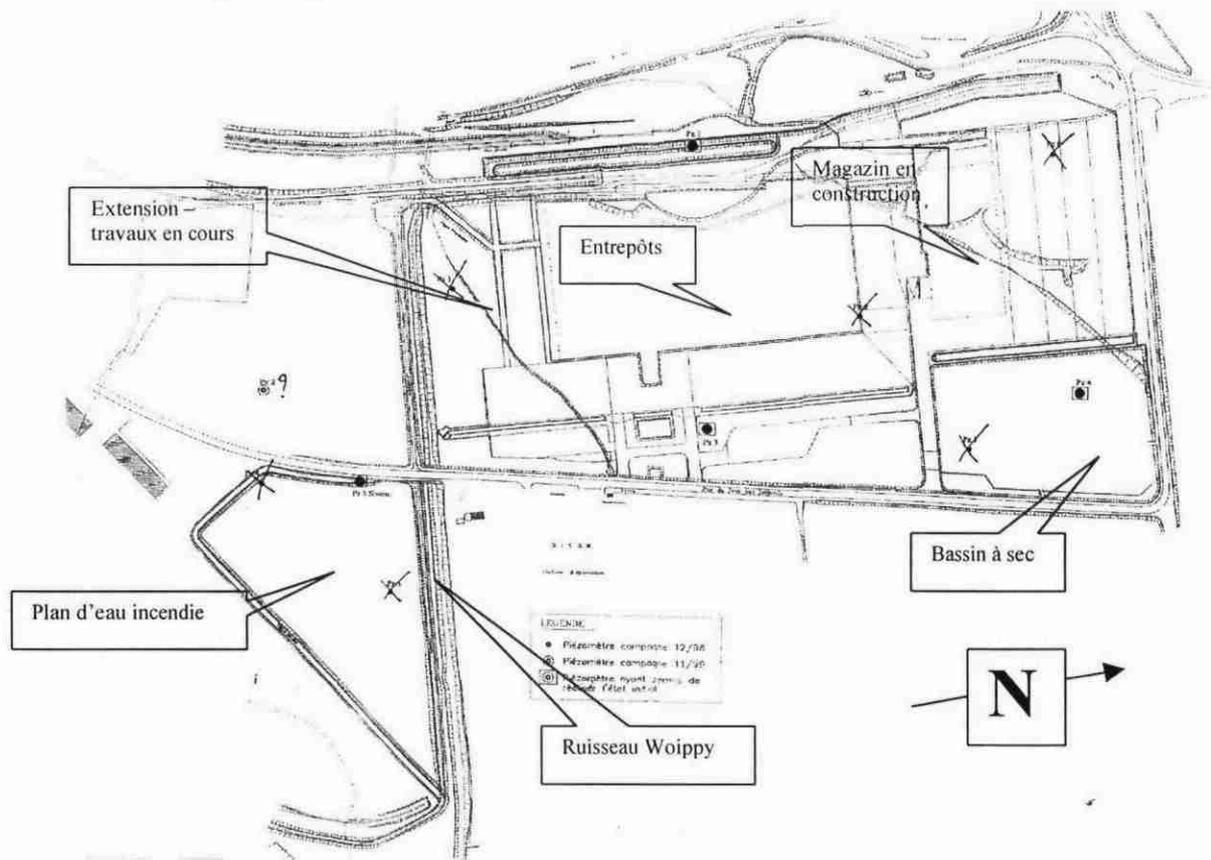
Plan du site IKEA – d'après SEBL (avril 2000)
